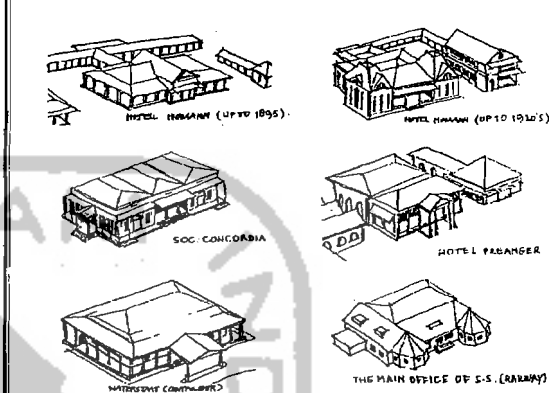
Bangunan sebelah kiri bersifat asimetris sedangkan sebelah kanan simetris sementara geometri fasade yang melandanya sama
